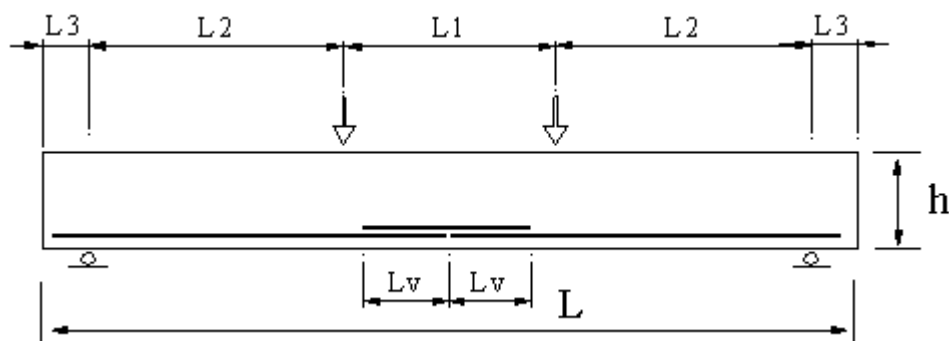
Vista lateral das vigas de cobrejunta.
